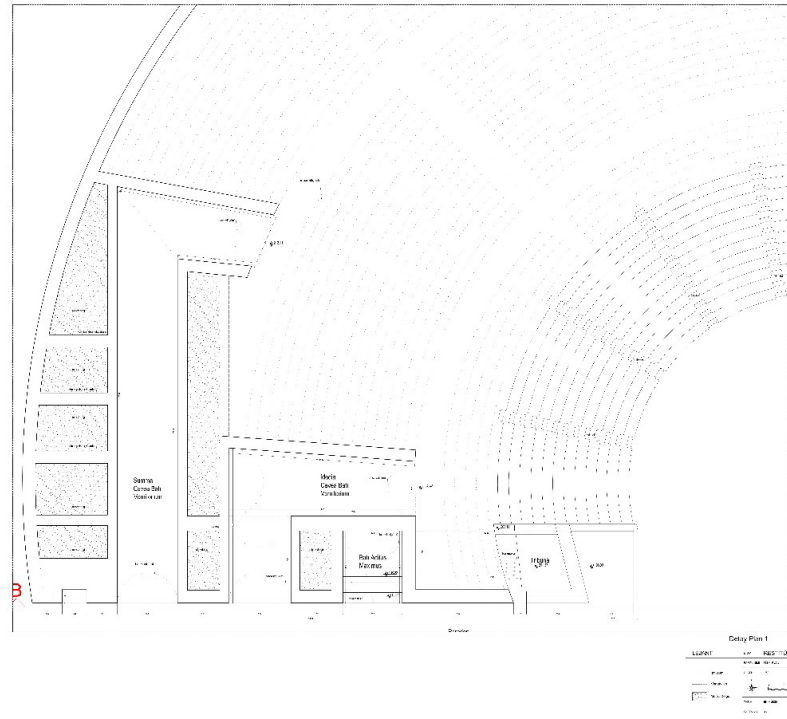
Prusias ad Hypium tiyatrosu planı. Batı bölümde cavealara girişi sağlayan L planlı tonoz örtülü galeriler.
